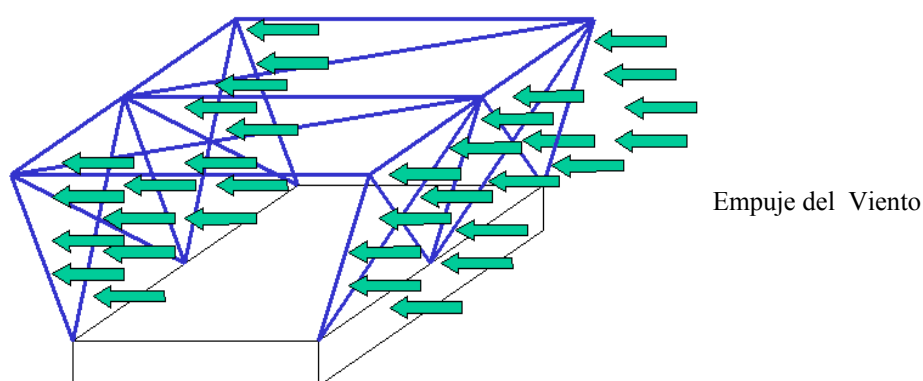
Croquis del empuje de viento sobre los elementos de la estructura.
